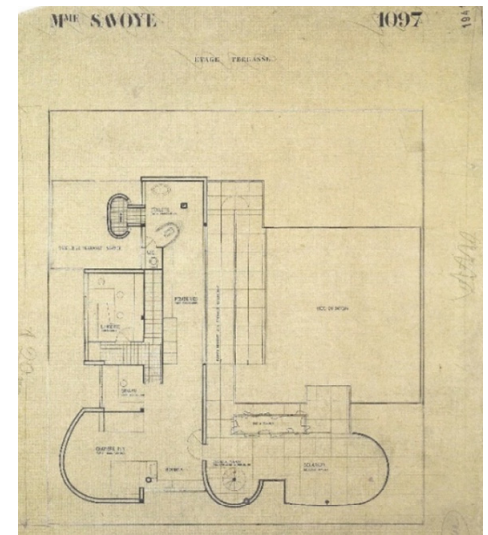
Vila Savoye, primeira proposta. Planta do segundo pavimento. Fonte: Fundação Le Corbusier.
